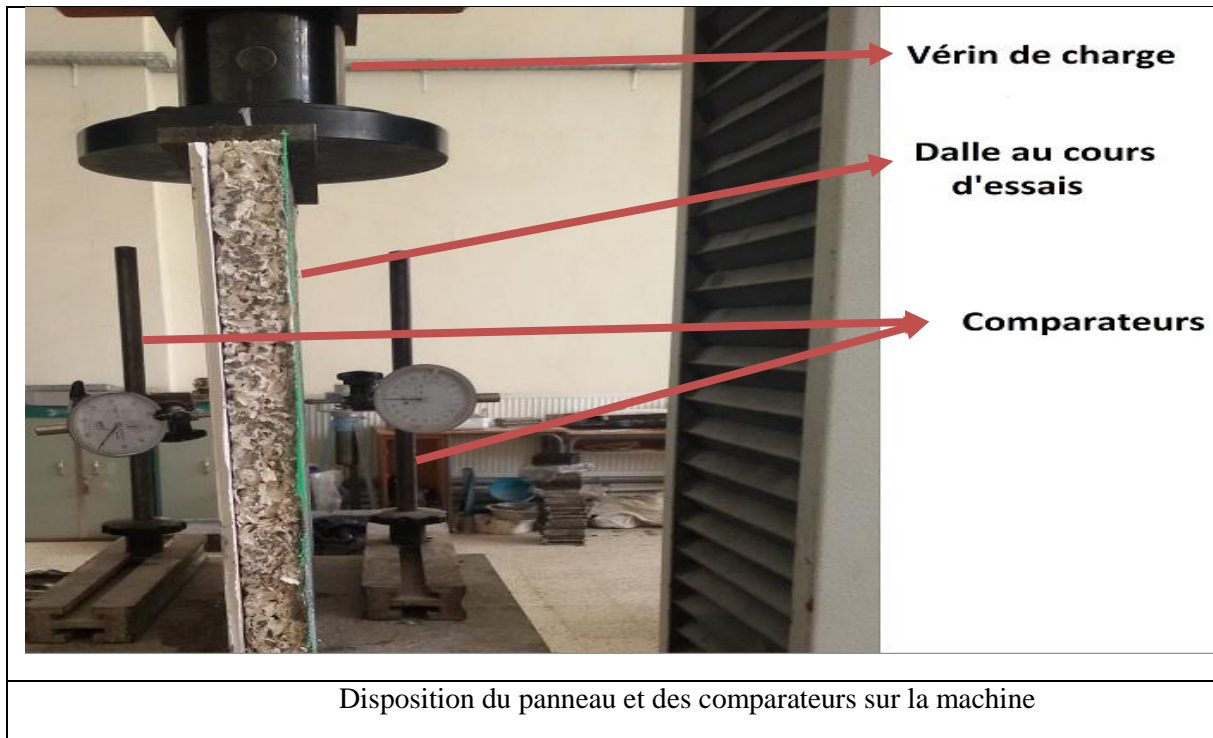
disposition des accessoires pour l'essai de voilement
